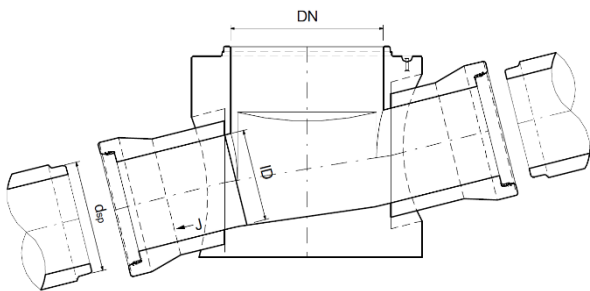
Anschluss mit CENTUB® Röser Stahlbetonrohre mit Gefälle  $J \leq 500 ‰$
